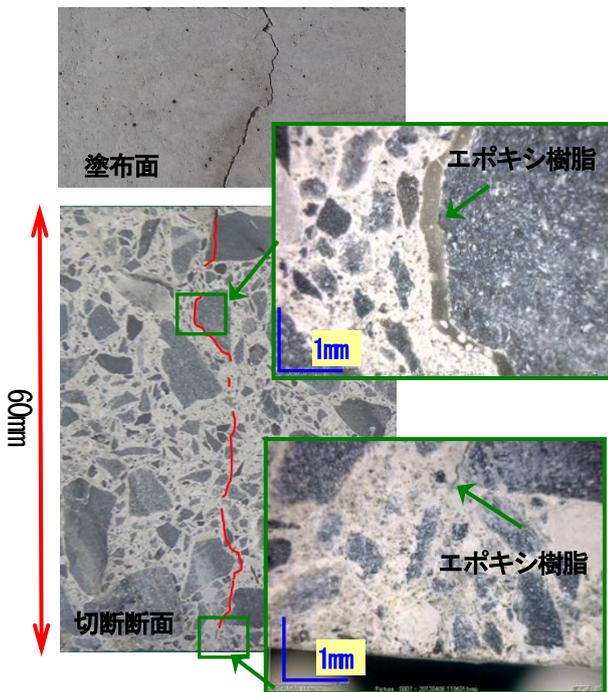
幅 0.2mm 程度のひび割れへの浸透系エポキシ樹脂の含浸状況
